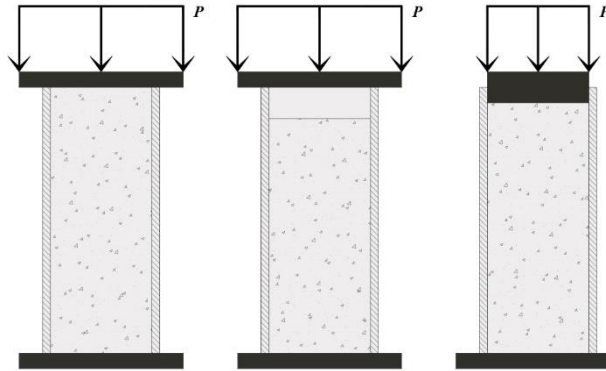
Aplicación de la carga: en toda la sección (izq.), únicamente al perfil de acero (cen) y solo en el núcleo de hormigón (der.)
